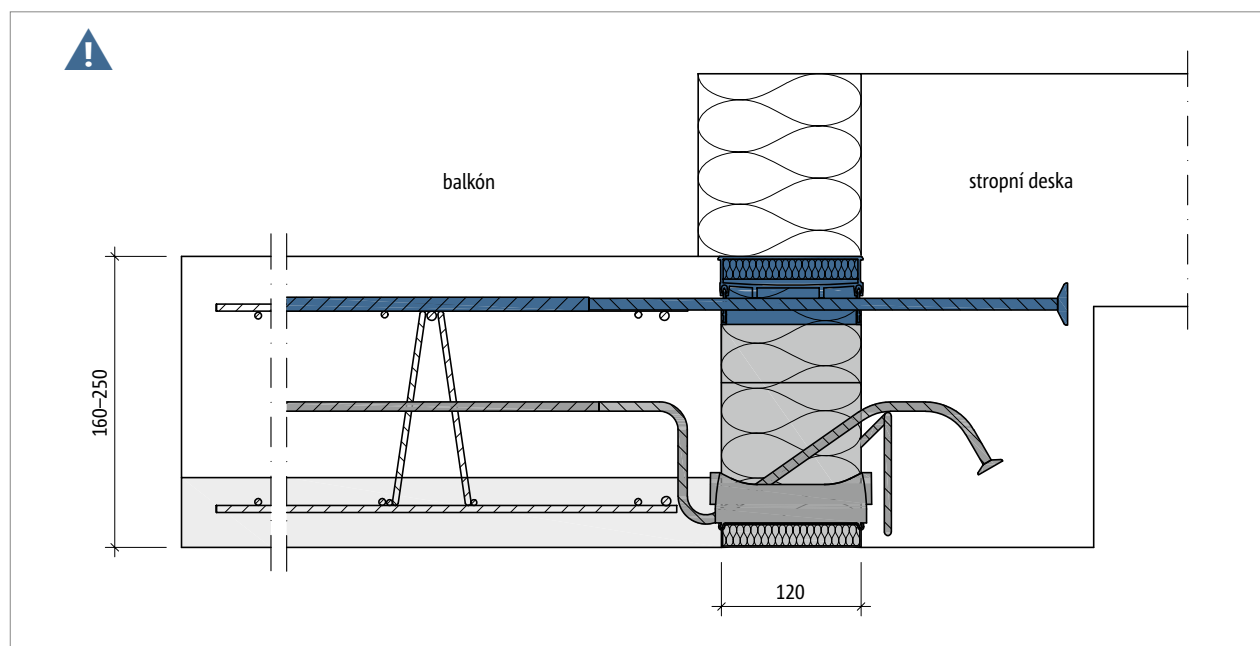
Schöck Isokorb® XT typ KL-O-F: Poloprefabrikovaný balkón nadvýškový oproti stropní desce
